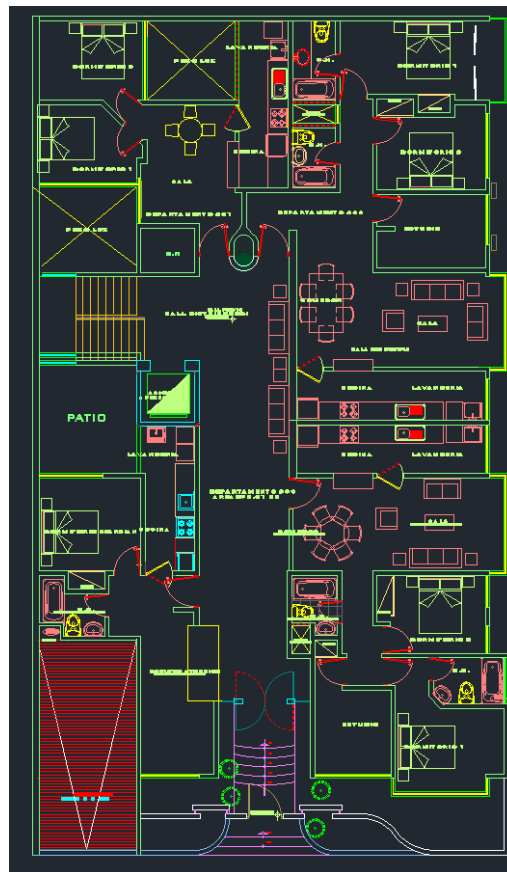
Vista en planta de Planta baja (Elaboración propia)
